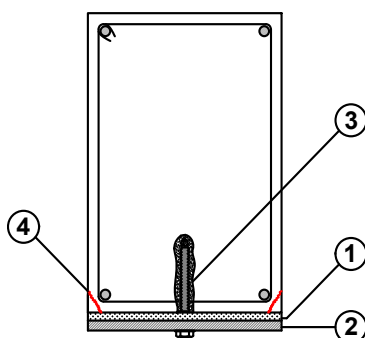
Tipologia 2: representação da secção transversal da viga reforçada. Legenda: 1 – resina epóxi; 2 - chapa metálica; 3 - bucha metálica.
